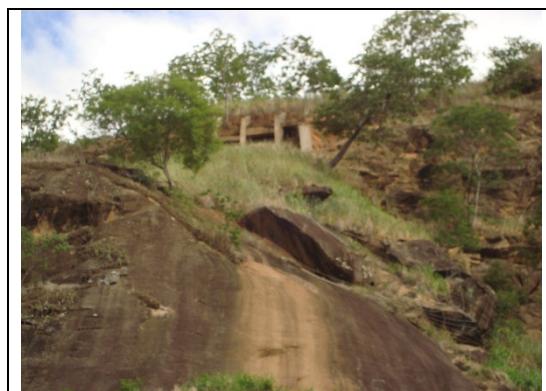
Uma das três estruturas de concreto para contenção de rochas soltas.
